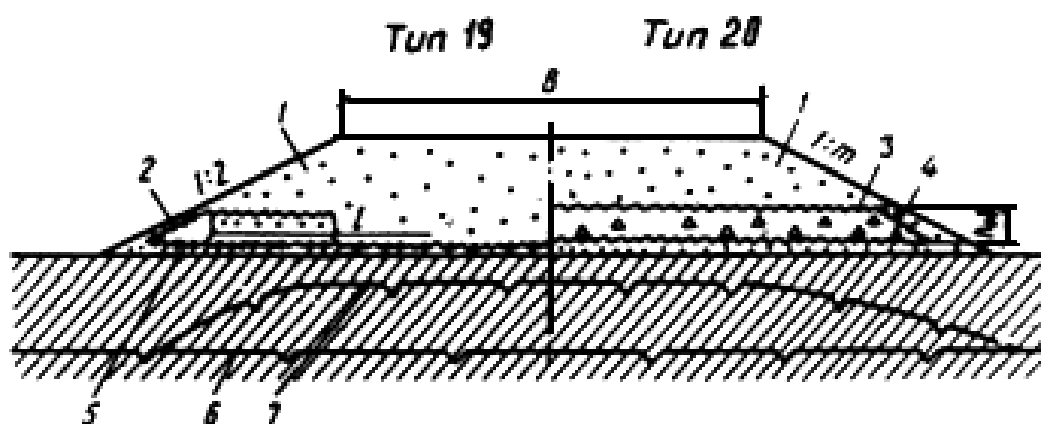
Поперечные профили насыпей с армирующими геотекстильными прослойками: 1 – грунт насыпи; 2 – полуобойма из геотекстиля; 3 – обойма из геотекстиля; 4 – грунт, в том числе твердомерзлый, в нижней части насыпи; 5 – выравнивающий песчаный слой толщиной 0,2–0,3 м; 6 – ВГВМ в естественных условиях; 7 – то же после постройки насыпи
